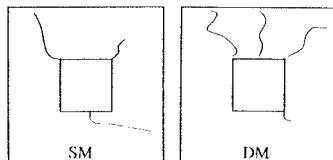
ひび割れ発生状況 (W/C=40%)
